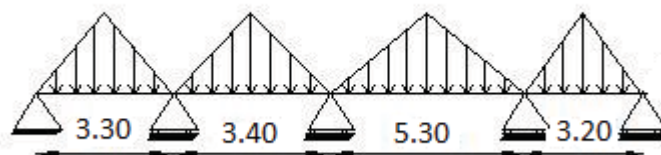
4: Distribution des charges sur les poutres secondaires
